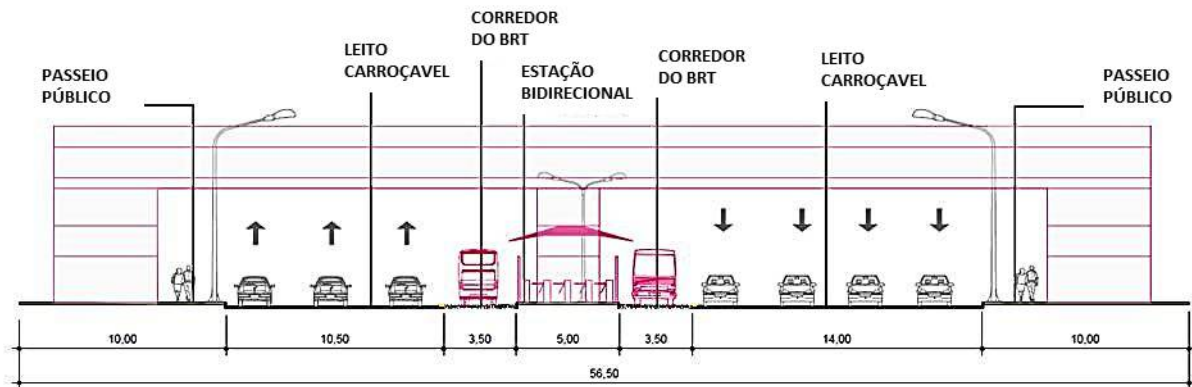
Corte Trecho B – Corte de Estação Bidirecional em canteiro central
